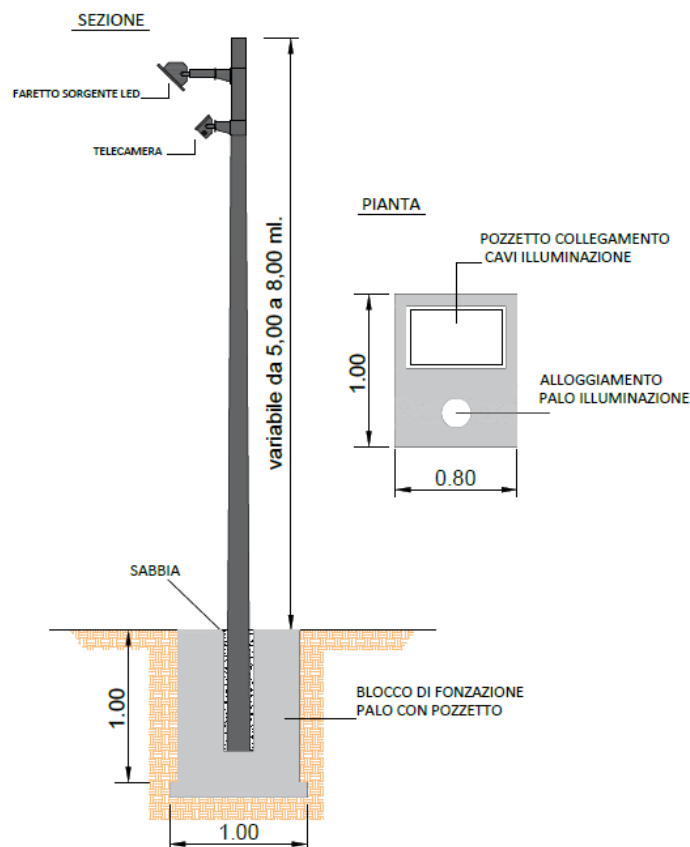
Particolare palo di illuminazione con pozzetto di fondazione e videocamera
